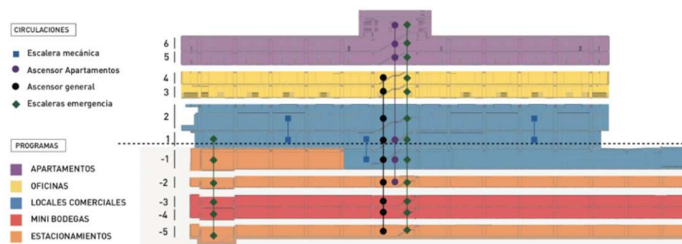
Esquema niveles Núcleo Los Trapenses. Fuente: (Núcleo Los Trapenses, 2020)
